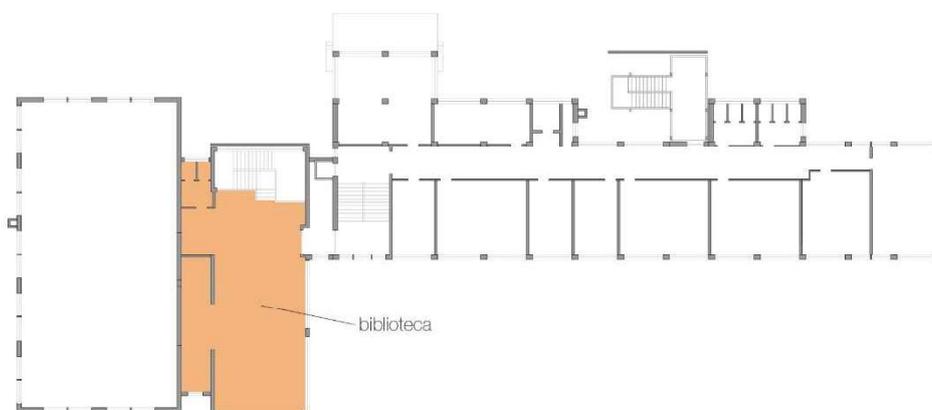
schematizzazione dell'intervento di realizzazione della biblioteca al piano primo.
